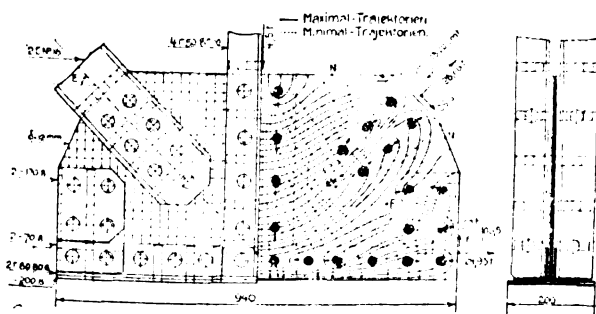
Disposition générale de l'assemblage 4 A (partie gauche) et tracé (partie droite).
